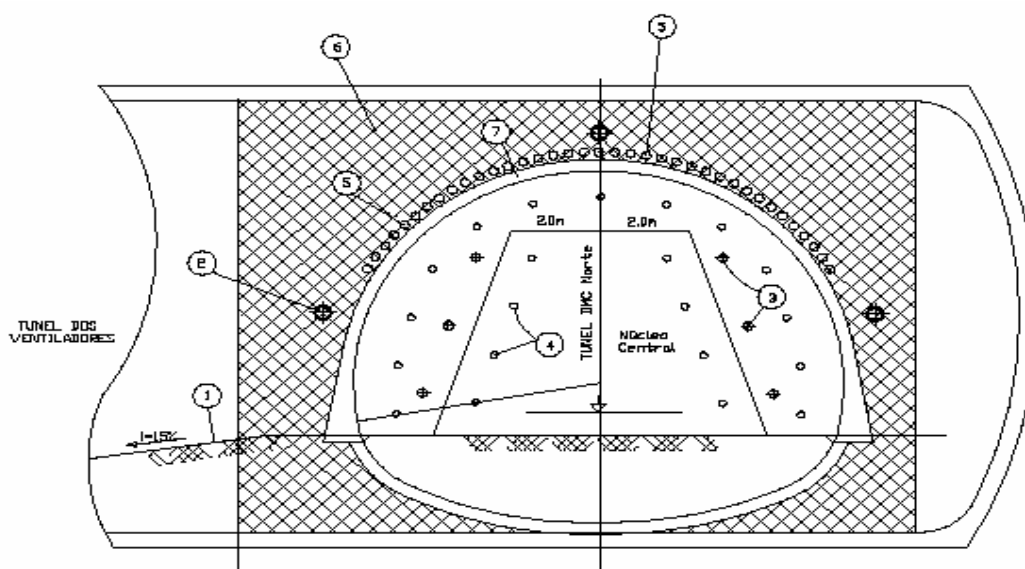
Término do Oriente. Emboquilhamento do túnel DMC Norte a partir do Túnel dos Ventiladores: 1-eixo do túnel; 2-dreno a vácuo; 3-drenos sub-horizontais; 4-pregagens; 5-enfilagens (colunas de *jet grouting*); 6-betão projectado reforçado com malha de aço. (Martins *et al.*, 2004)
